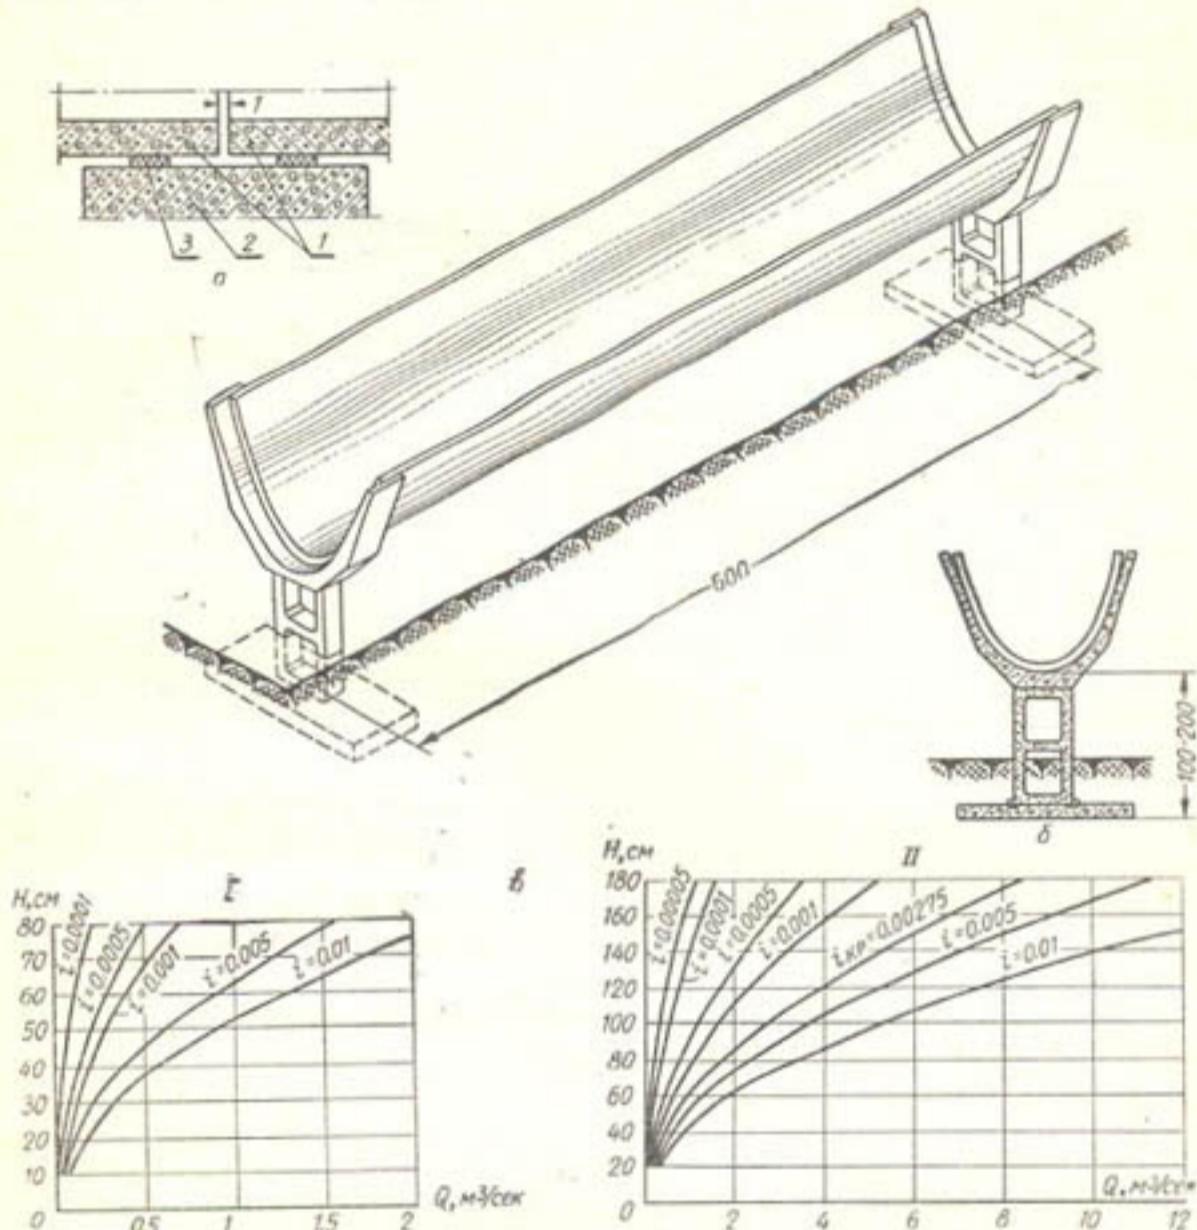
Параболические лотки из ненапряженного железобетона длиной 6 м на рамных опорах:
